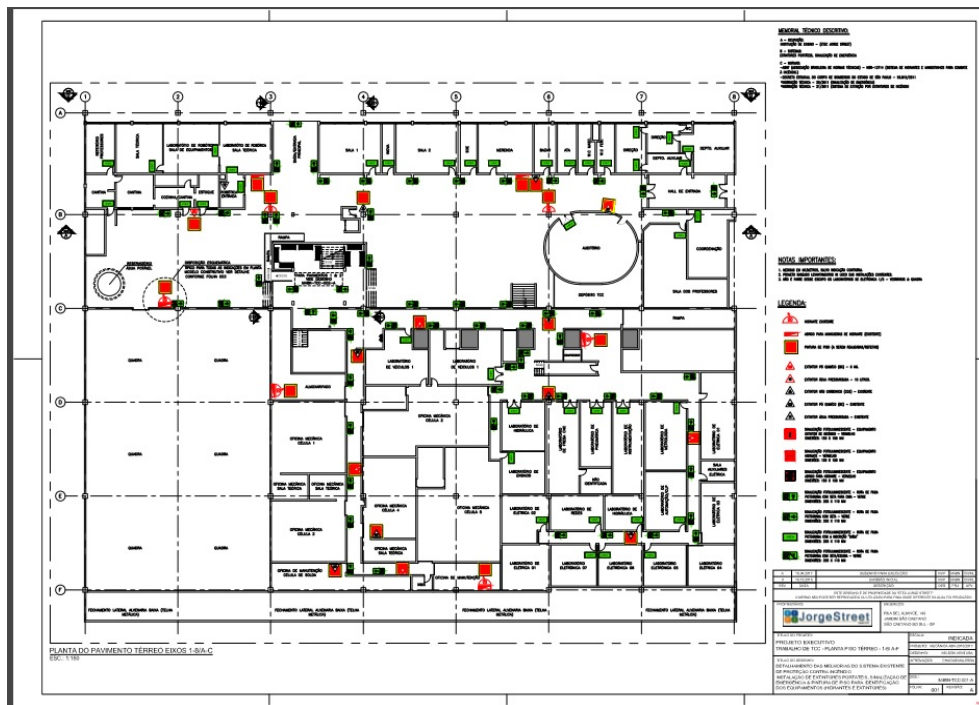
Planta do pavimento térreo e células da ETEC JORGE STREET
